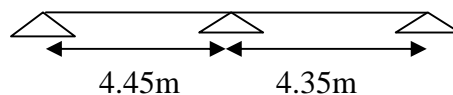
Schéma statique du 2ème type de poutrelles.
